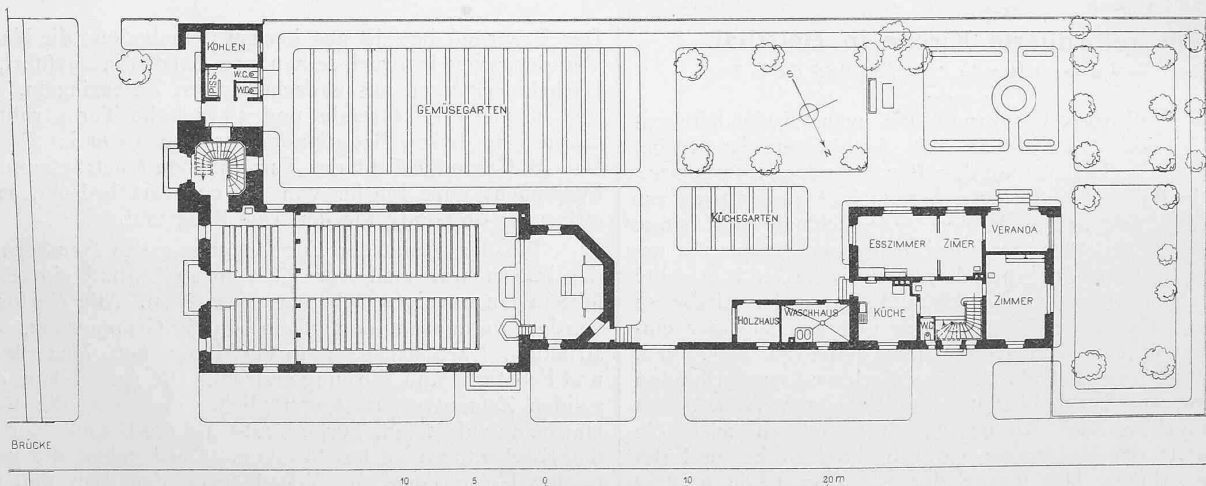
Grundrisse vom Erdgeschoss der neuen reformierten Kirche und des Pfarrhauses zu Balsthal. — Masstab 1 : 500.
